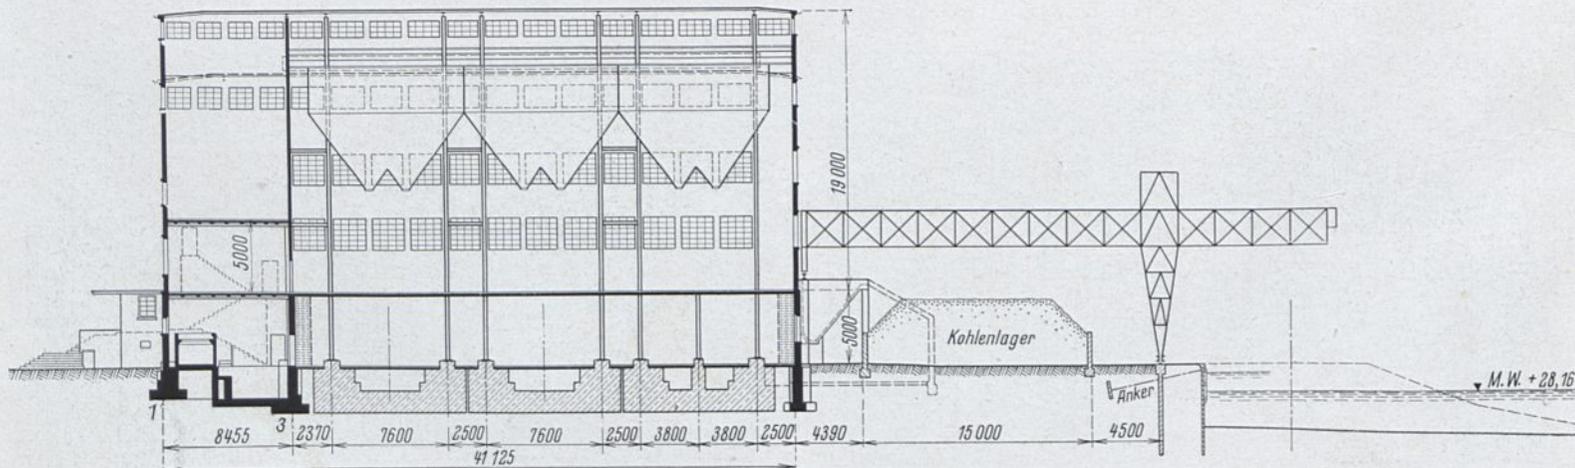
Längsschnitt durch Kessel- und Pumpenhaus.
